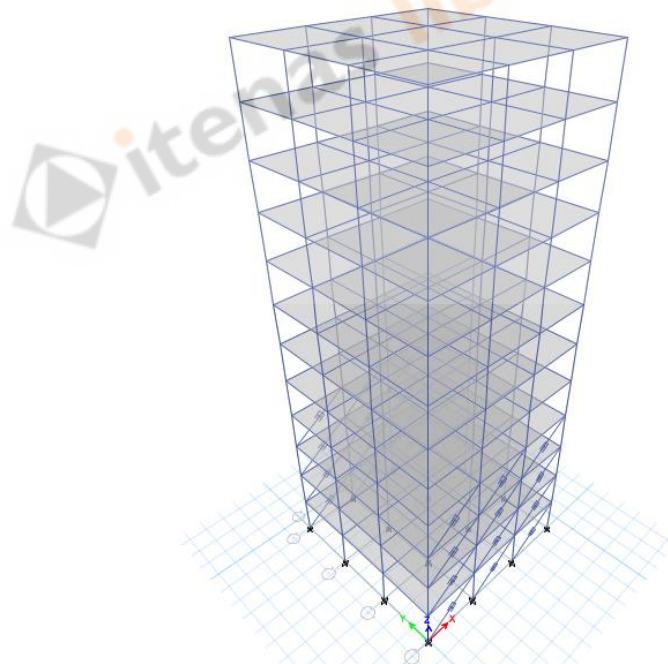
Denah Gedung Tinggi 12 Lantai
